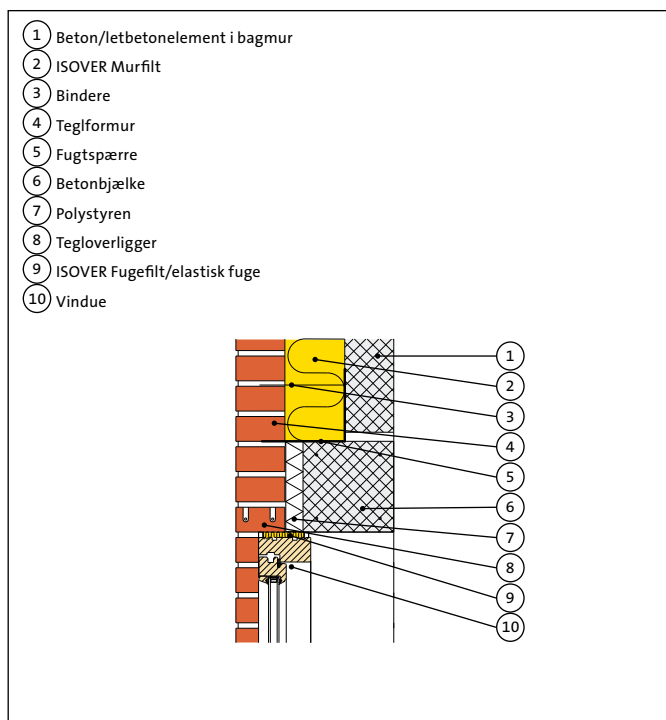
Tegloverligger og bagmur i beton/letbeton og betonbjælke.
